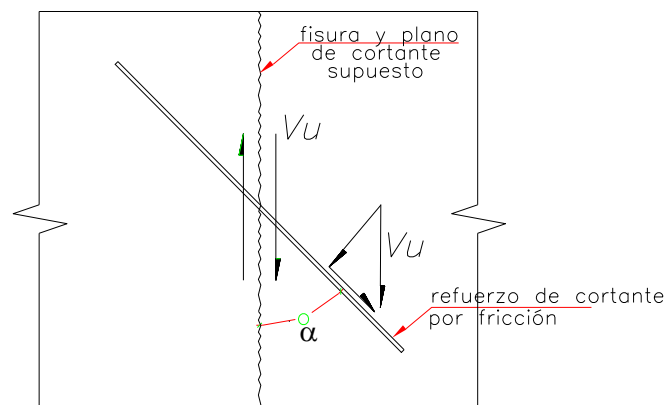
Refuerzo de cortante por fricción inclinado con respecto a la fisura supuesta.
